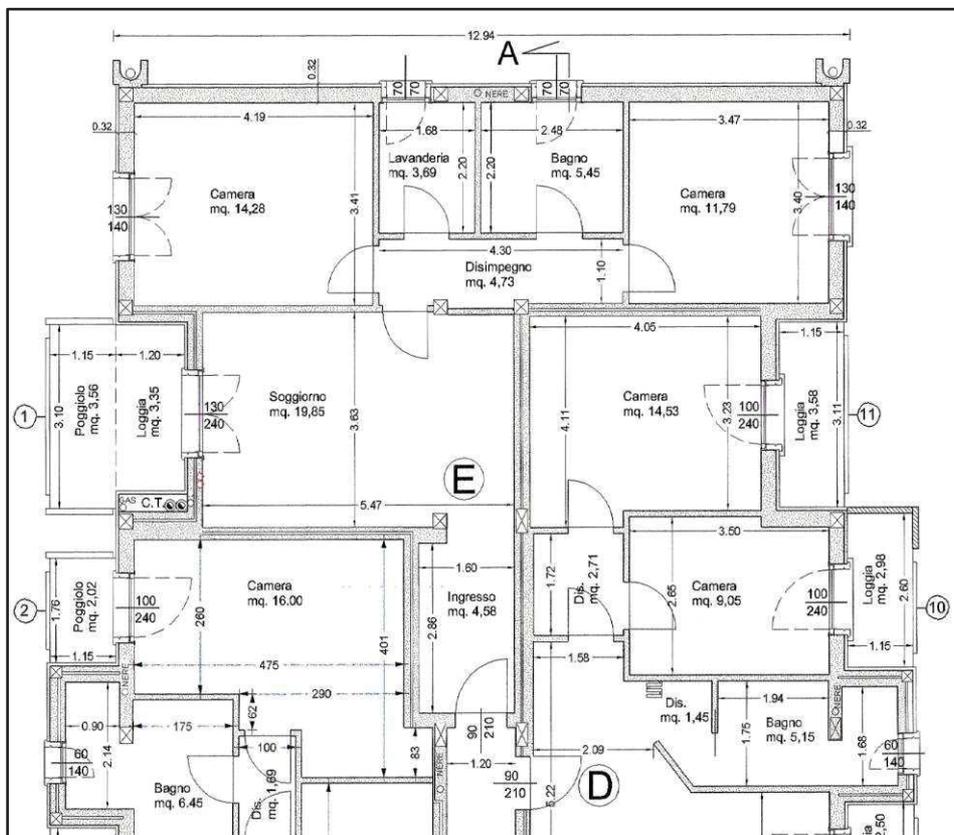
Pianta dell'appartamento tratta dai disegni di progetto (non del tutto aderente allo stato di fatto)
